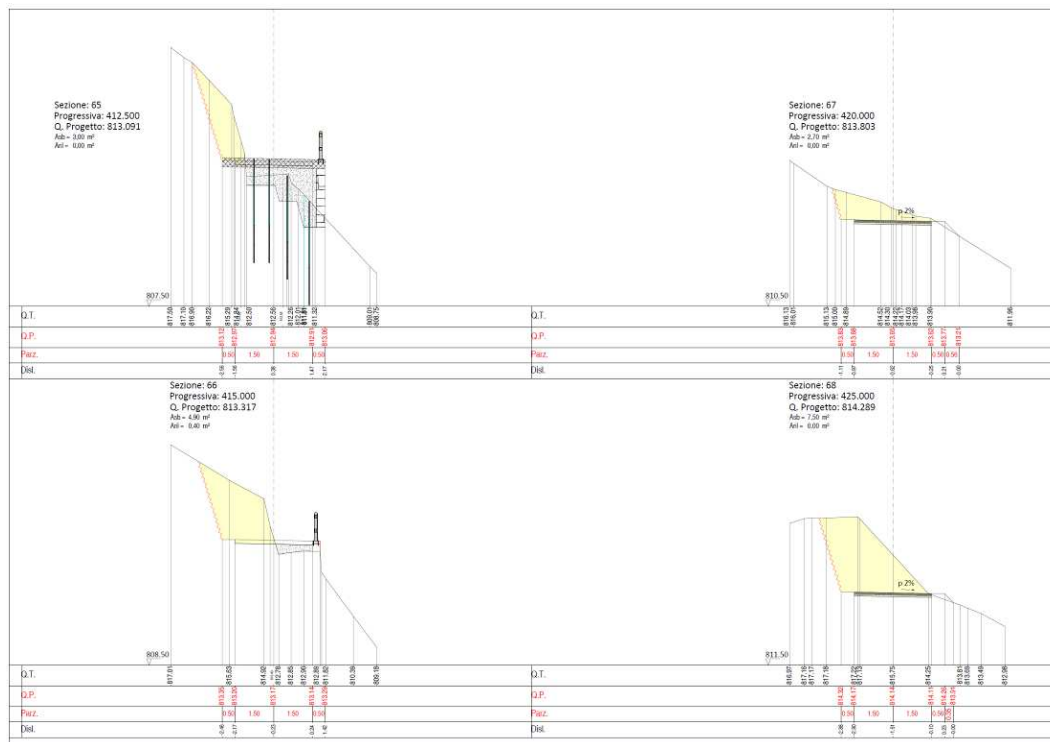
estratto sezioni di progetto più significative tratto iniziale pista in progetto
